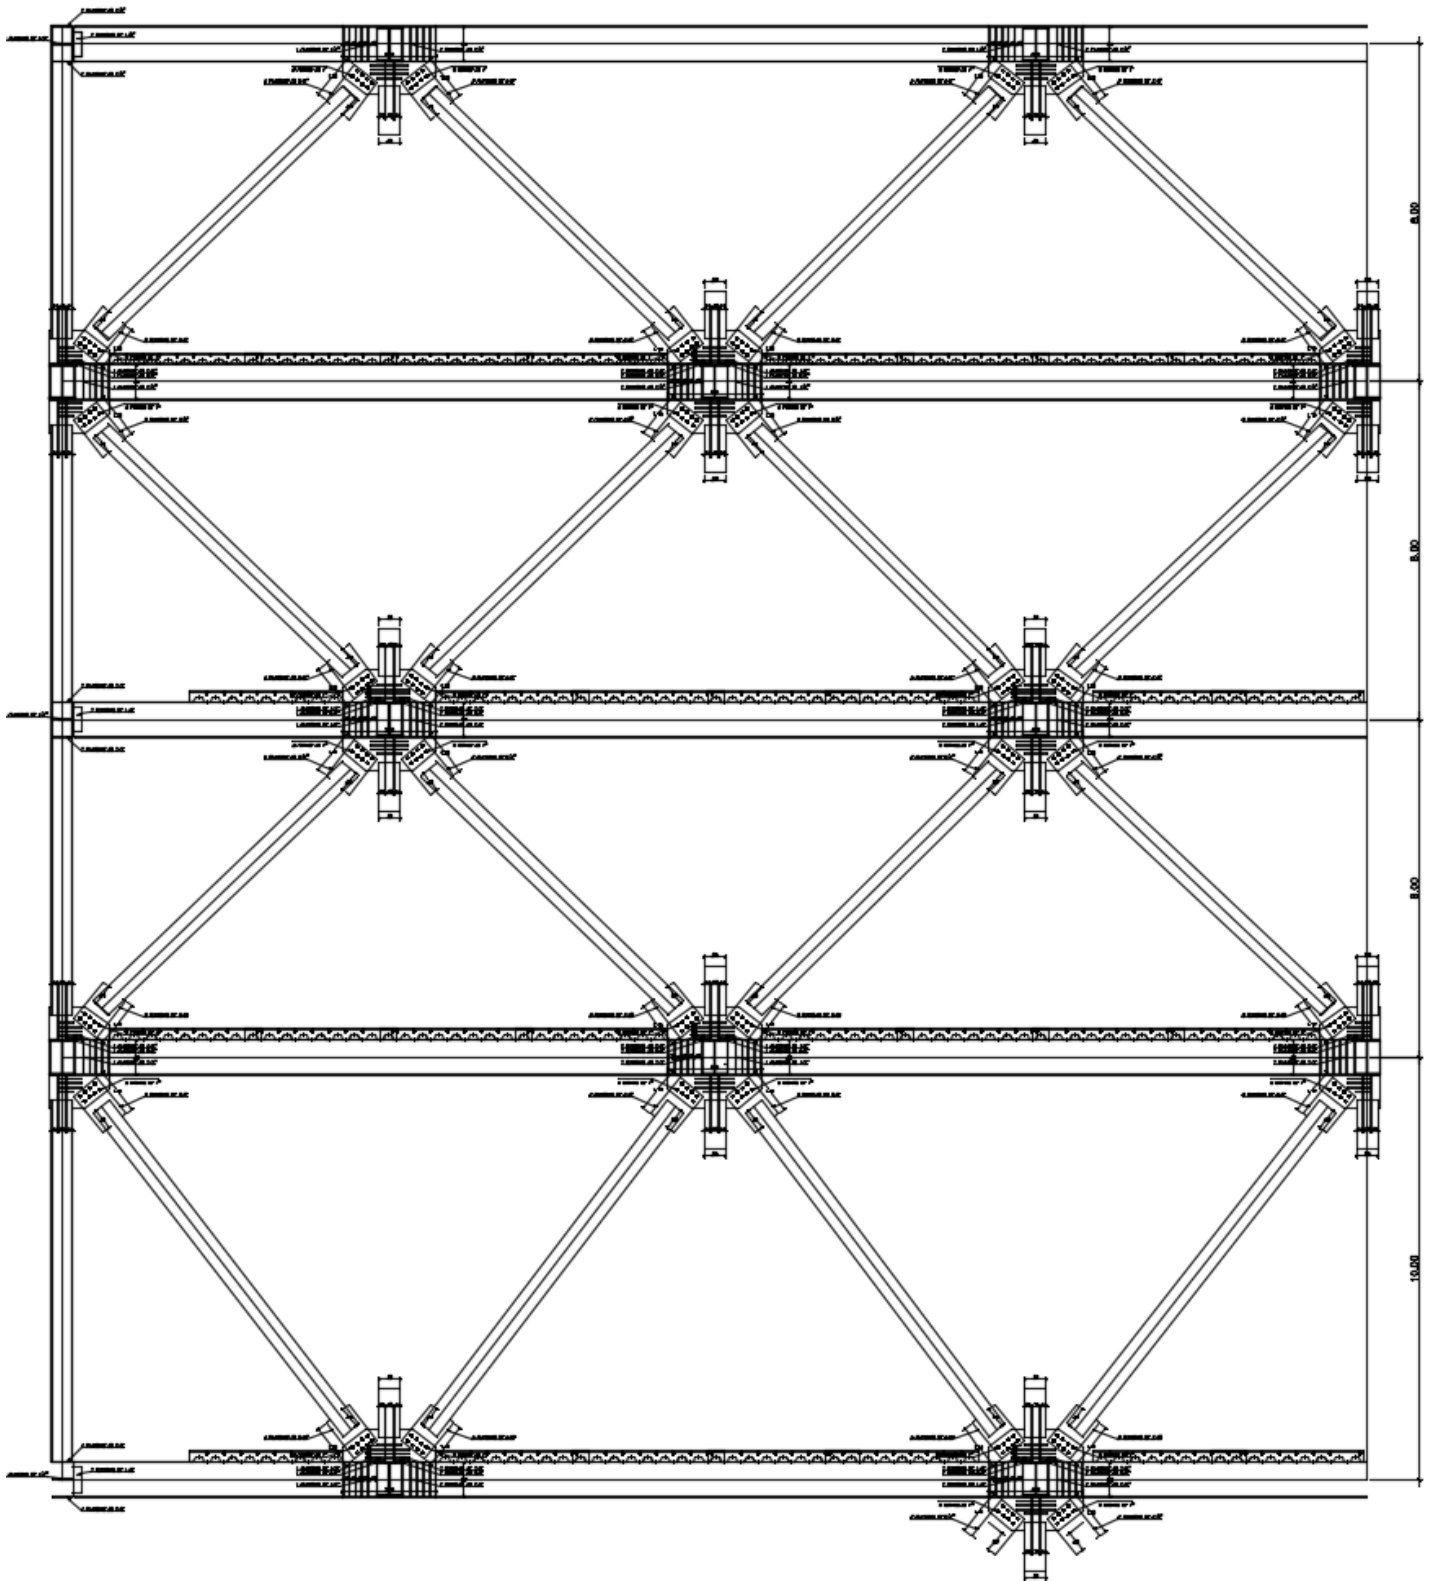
Corte del sistema estructural. Elaboración: la autora.
